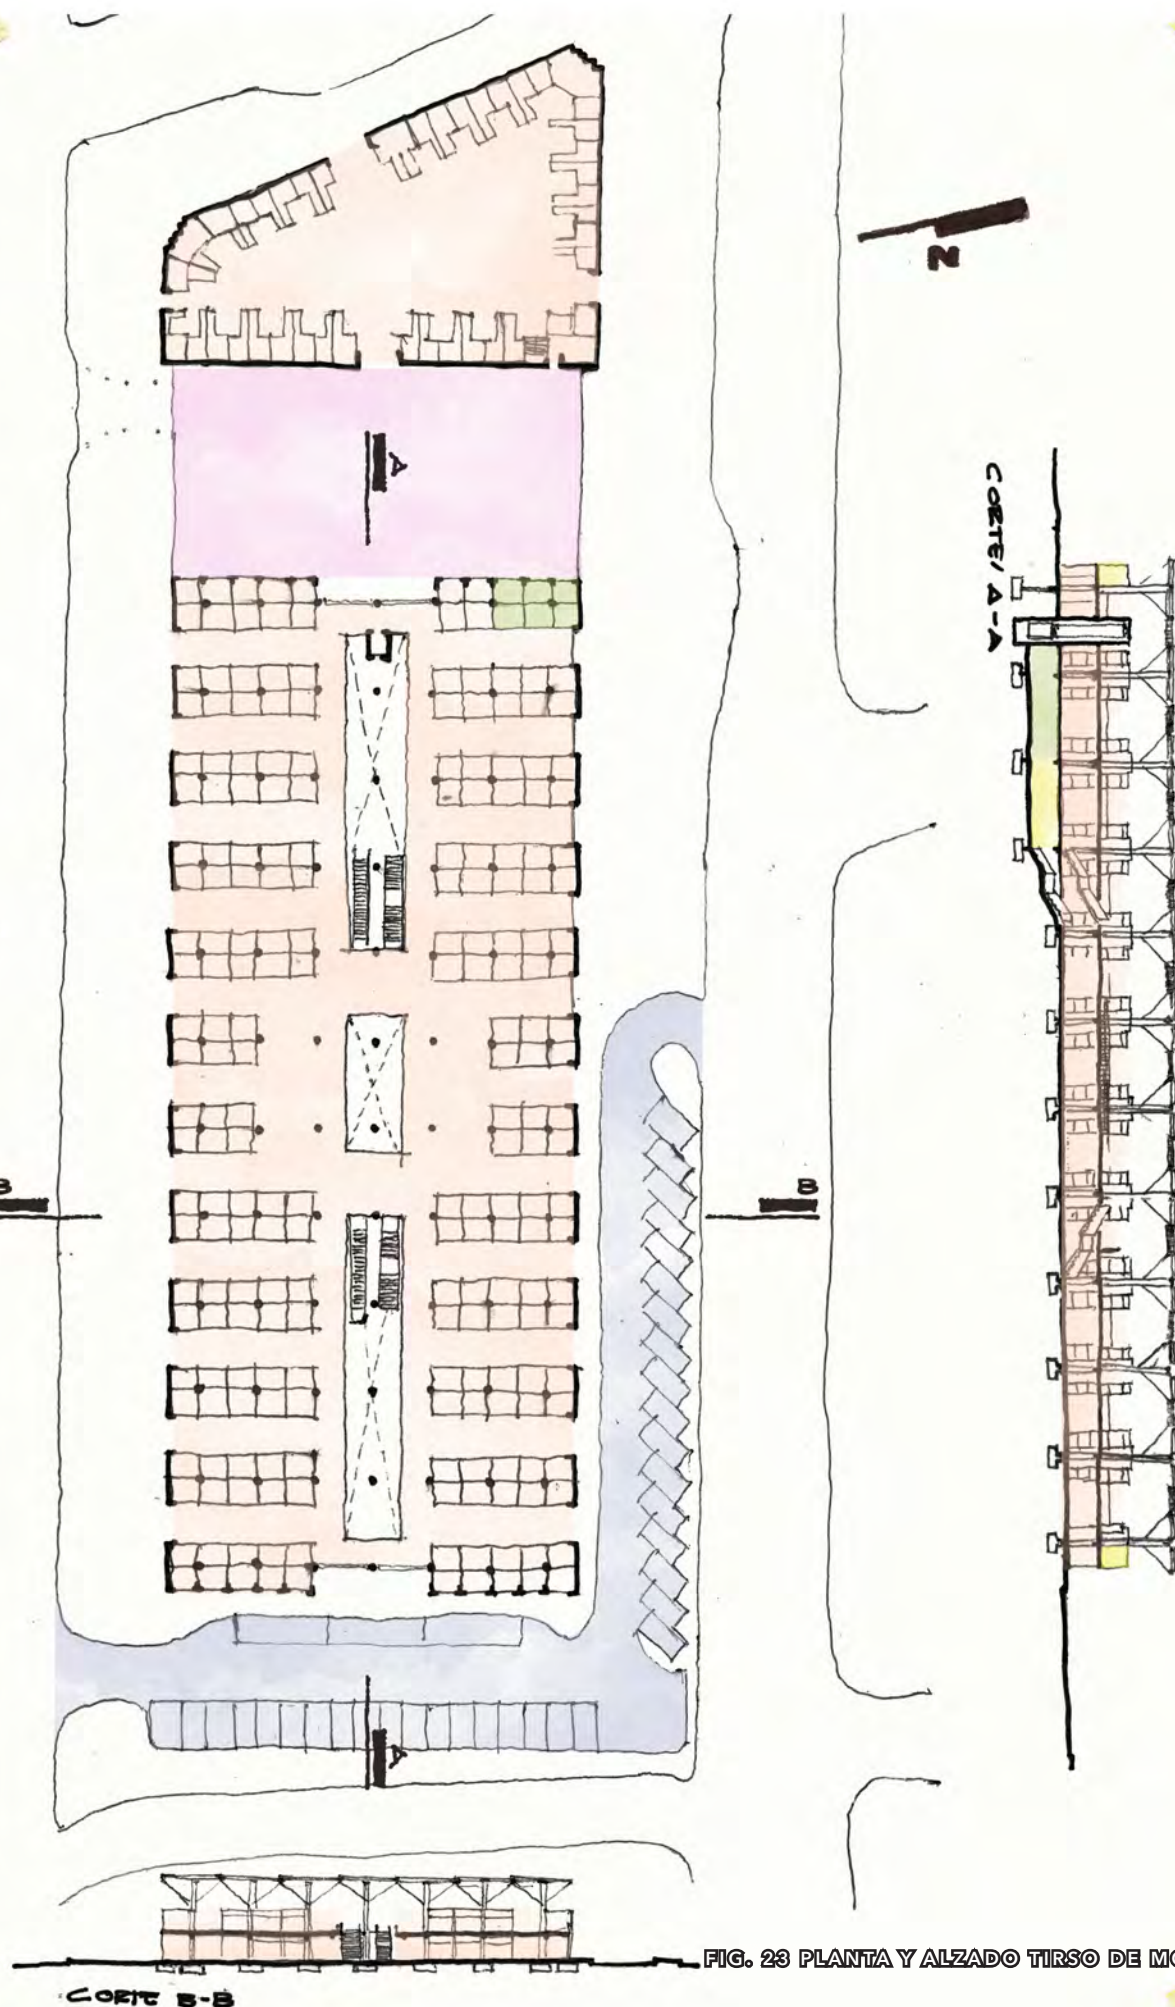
PLANTA Y ALZADO TIRSO DE MOLINA.
